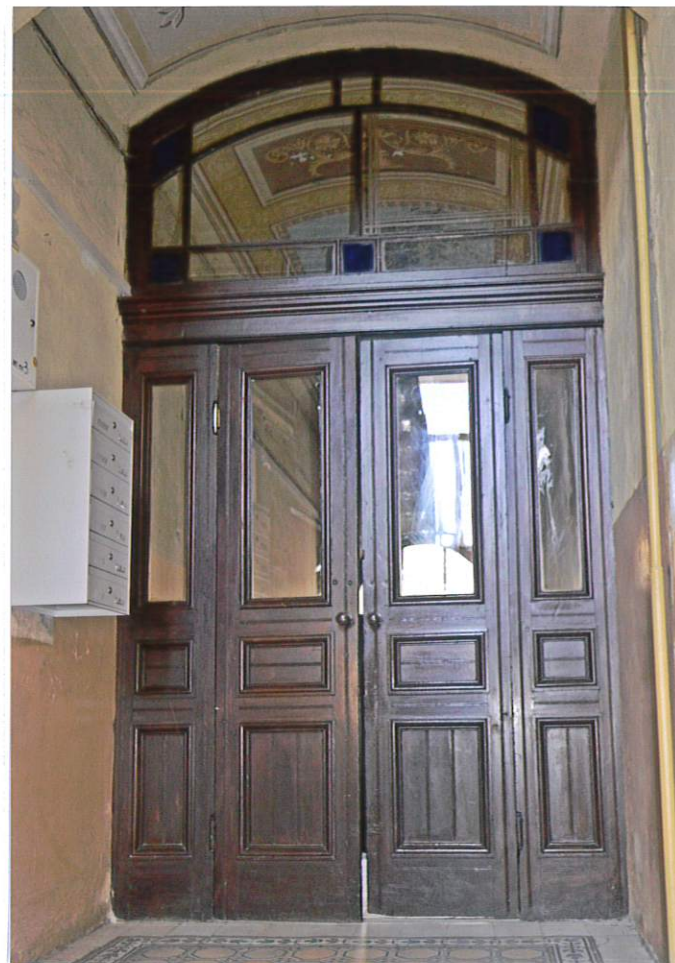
Główna klatka schodowa - posadzka przy drzwiach przedsionka.
